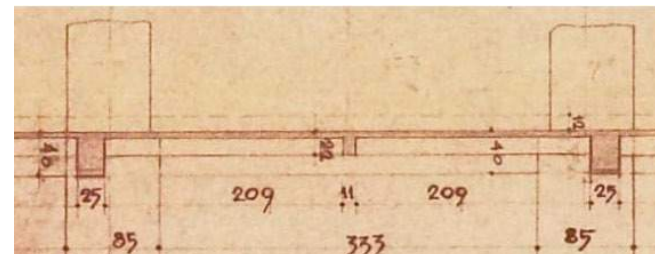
SECCIÓN DEL FORJADO BIDIRECCIONAL
